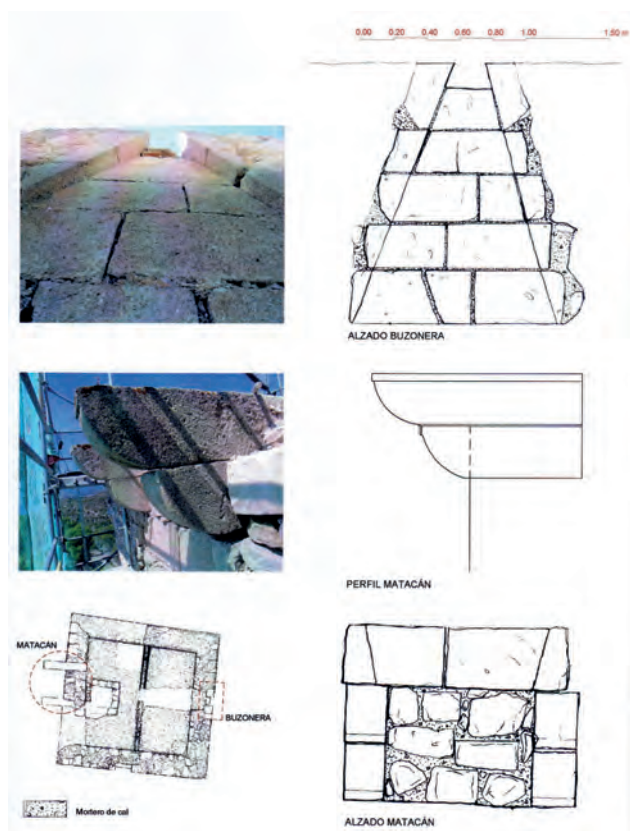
Alzado y planta de la ladronera que remata la torre de Aquiló (La Vila Joiosa). ARPA Patrimonio.
